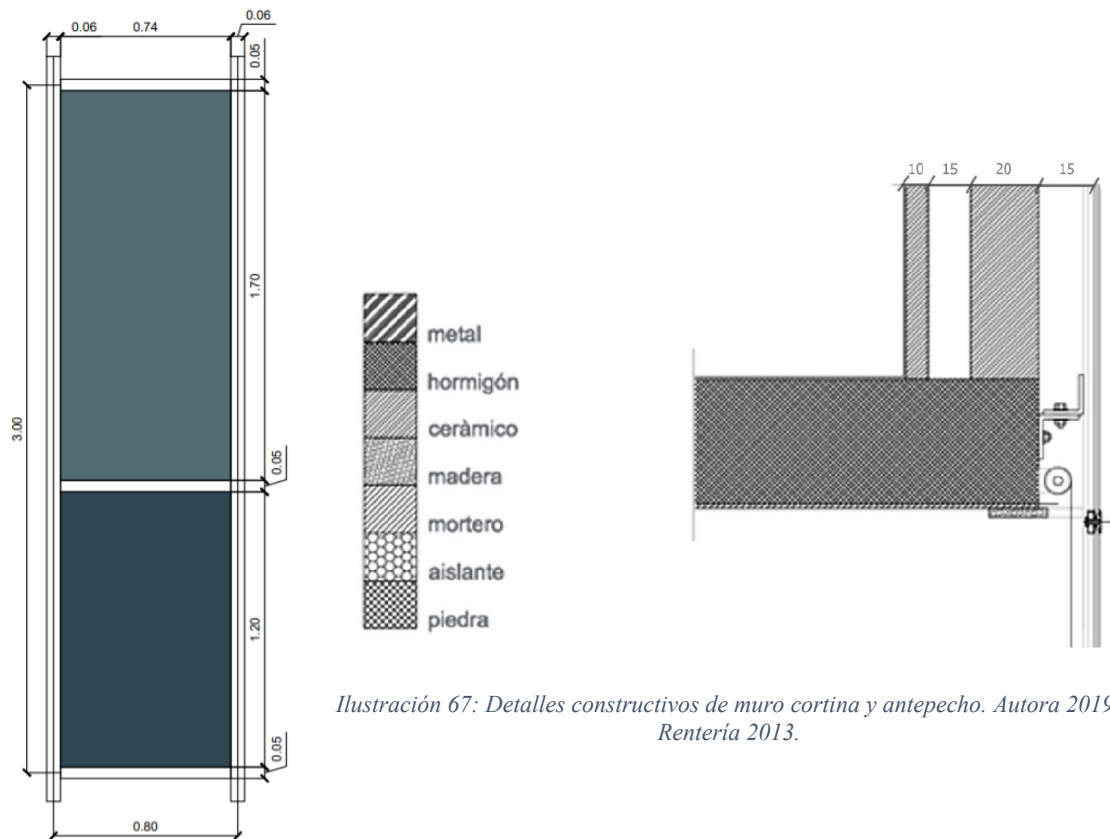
Detalles constructivos de muro cortina y antepecho. Autora 2019; Rentería 2013.
